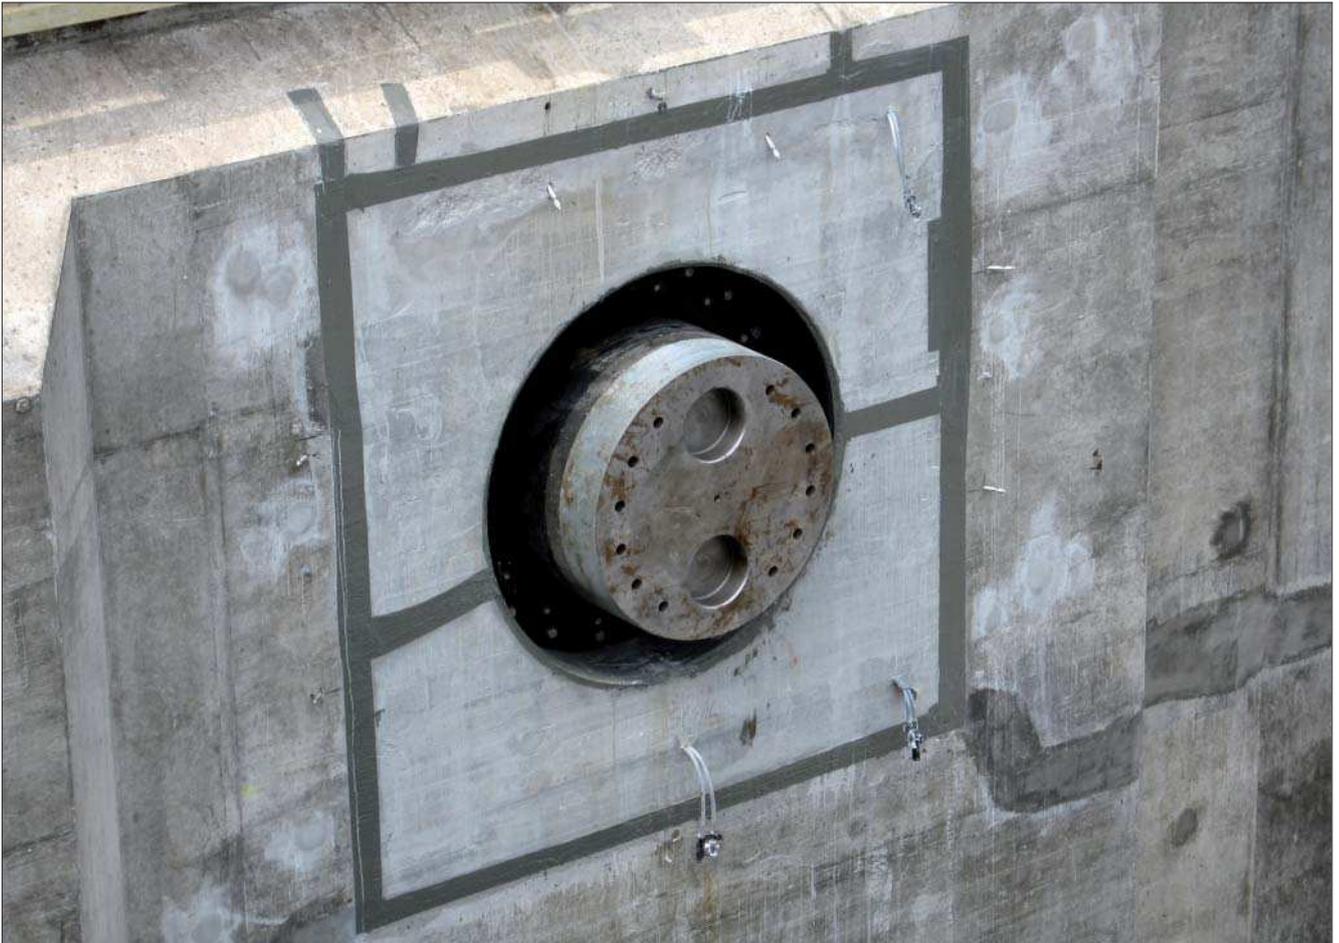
Drehsegmenttorlager nach dem Zweitbetoneinbau
